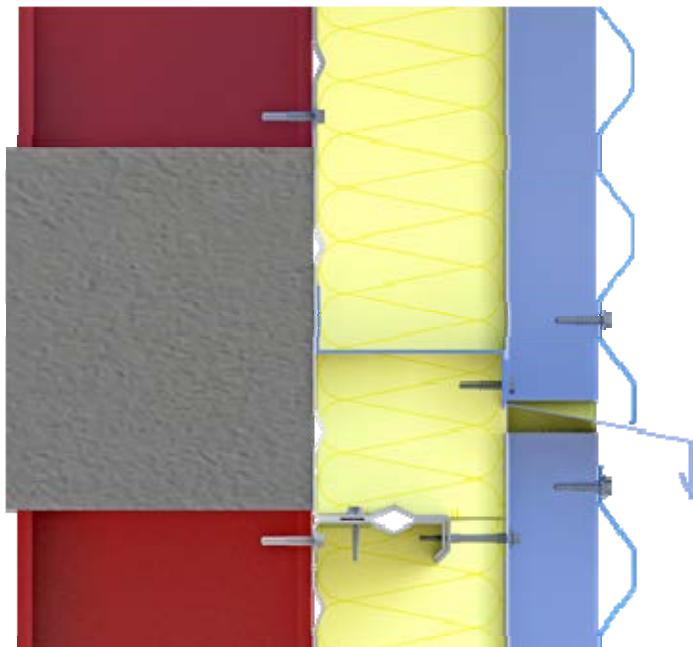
Détail du fractionnement au droit des planchers pour la pose en zones sismiques
